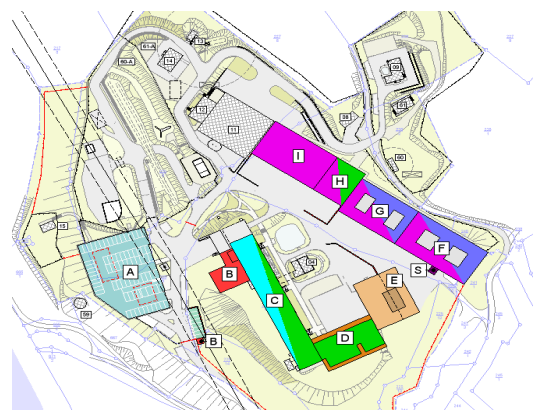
Variante A2, A Parkdeck, Regenrückhaltebecken, Kläranlage, B Anfahrtsgebäude, Wache, C Verwaltung/Lehr- und Ausbildung, D Multifunktionsgebäude, Lehr- und Ausbildungsbereich, E Technik- und Versorgungsgebäude, F Fahrzeughalle mit Unterkunft, G Fahrzeughalle mit Unterkunft, H Fahrzeughalle mit Atemschutzwerkstatt, I Fahrzeughalle, S Schlauchturm
